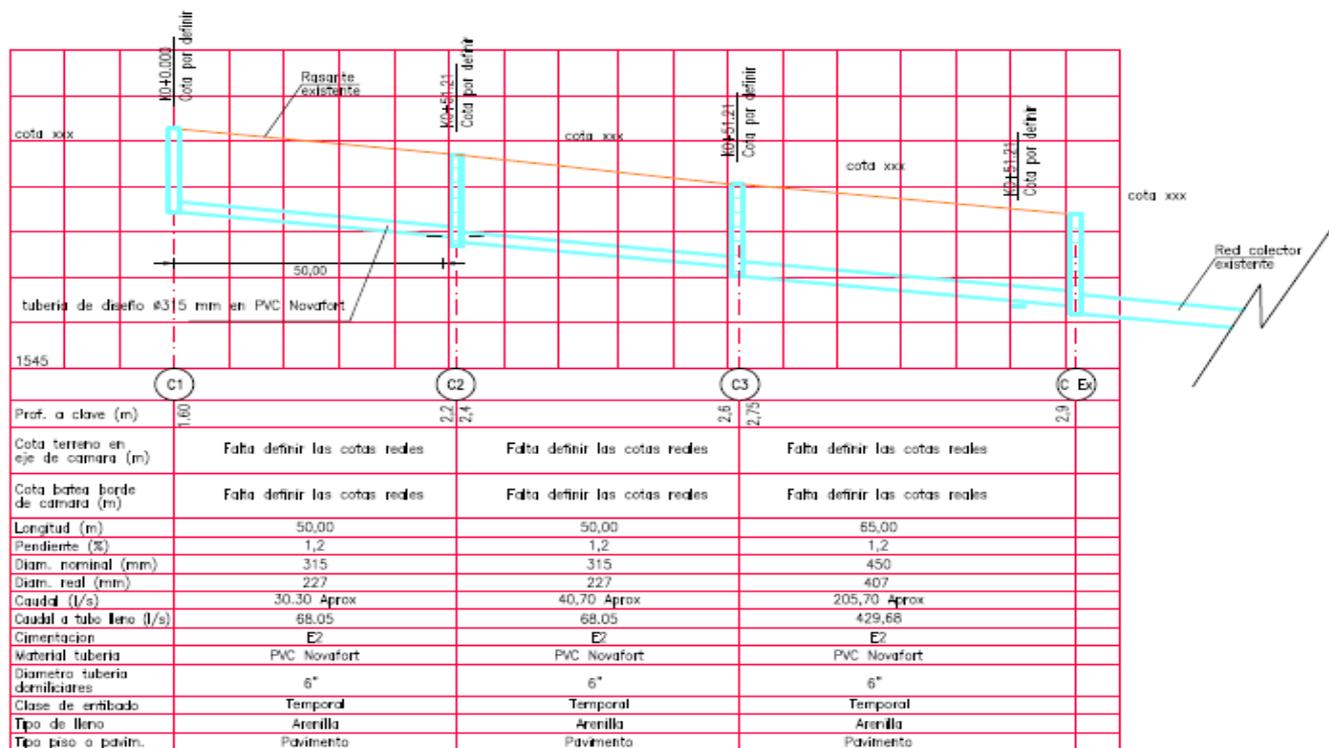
Planta red de alcantarillado aguas residuales barrio Belalcázar.
